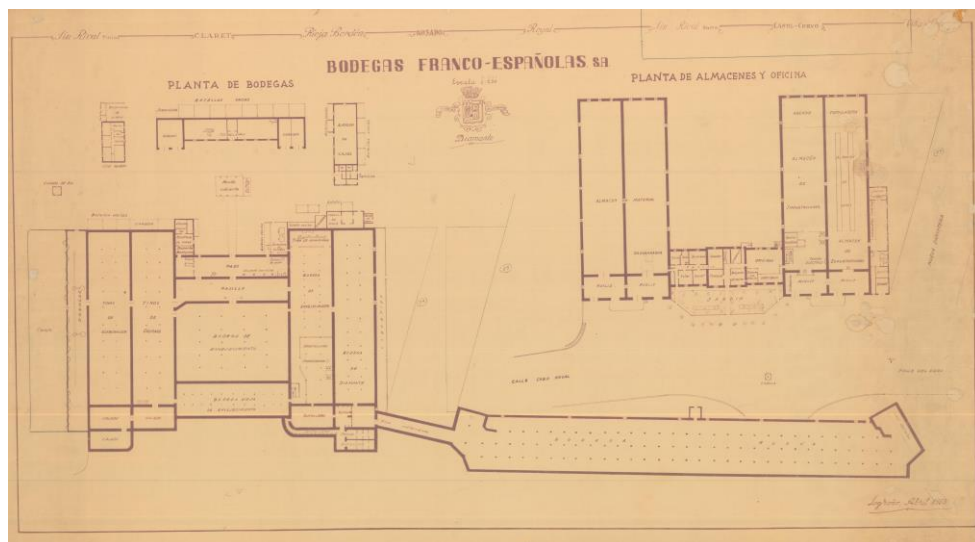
Plano de planta de bodega dibujado en abril de 1963.
